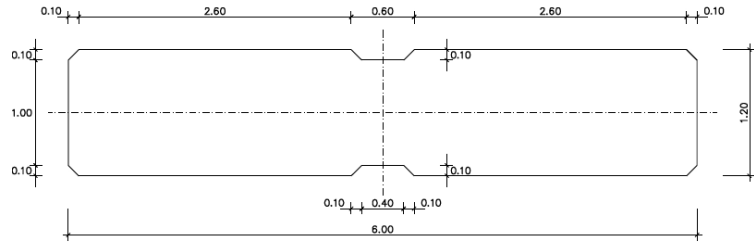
Sección tipo de pilas P.S. 9.6
